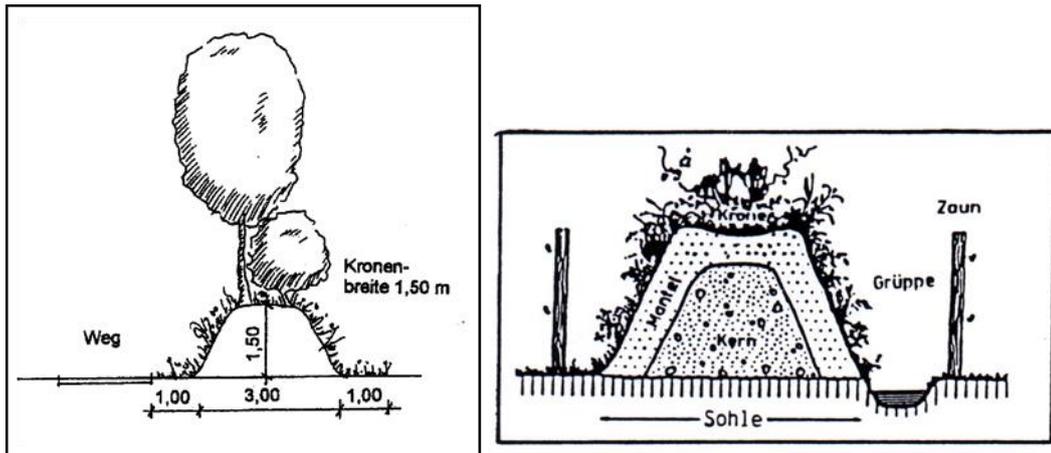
Aufbau und Querschnitt einer Wallhecke (schematisch)
